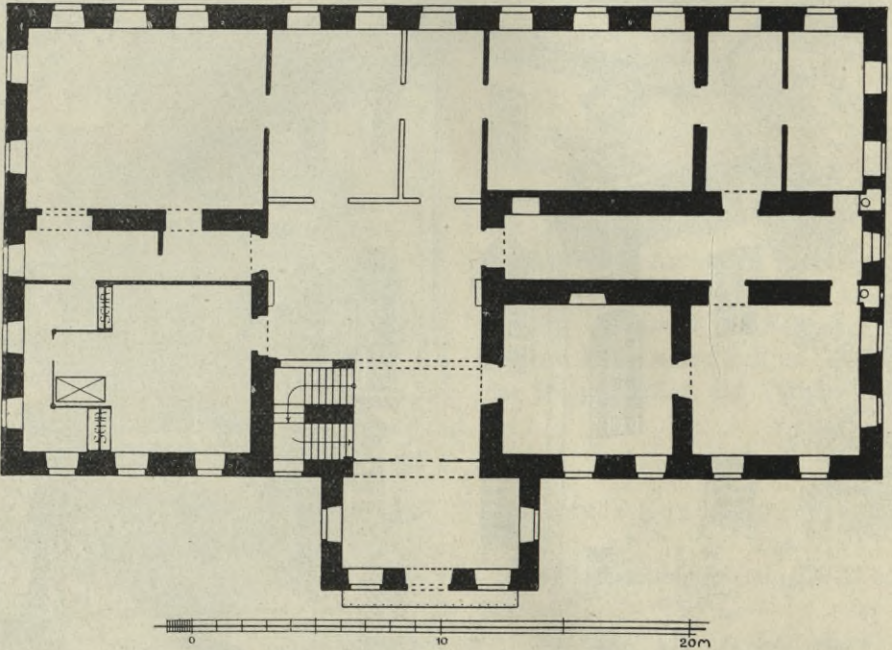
Wurschen, Schloß, Grundriß des Obergeschosses.
